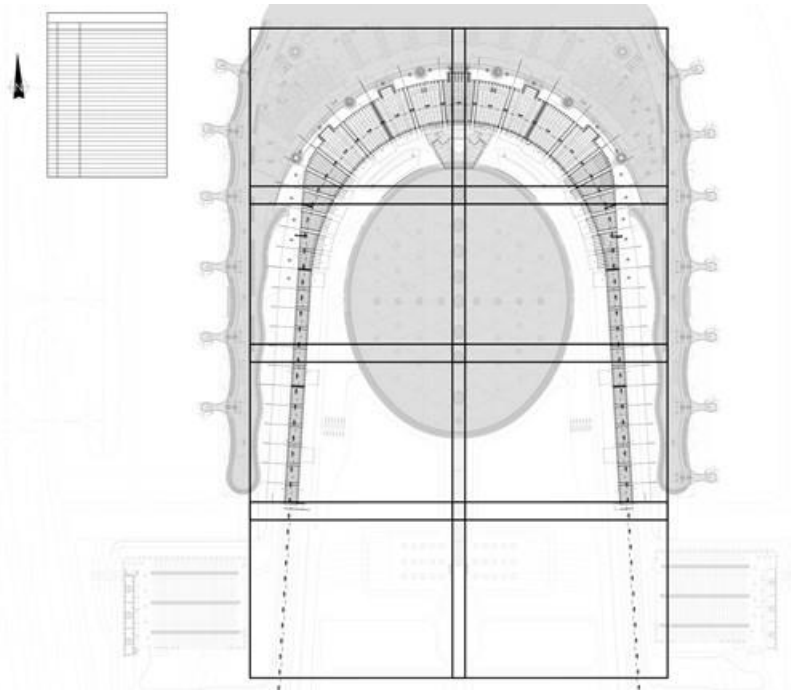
Planta del viaducto de acceso y de las estructuras cercanas (información proporcionada por Parsons)
